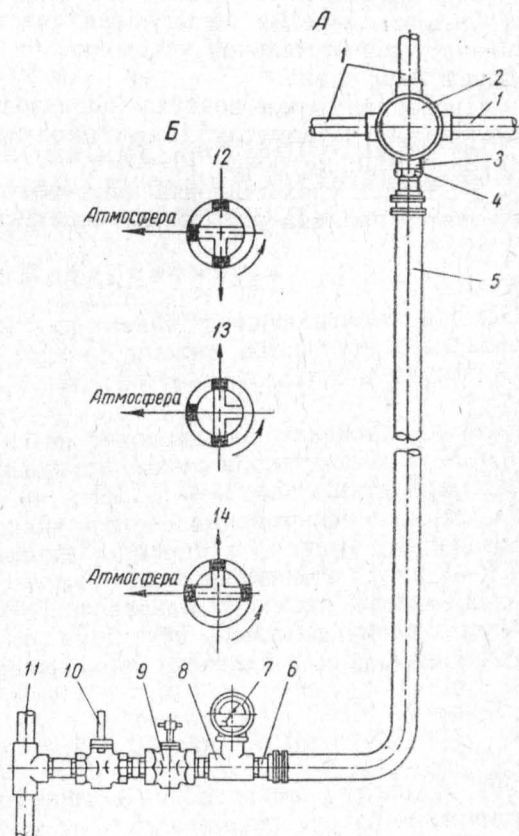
Испытание трубопроводов на плотность повышенным давлением:
